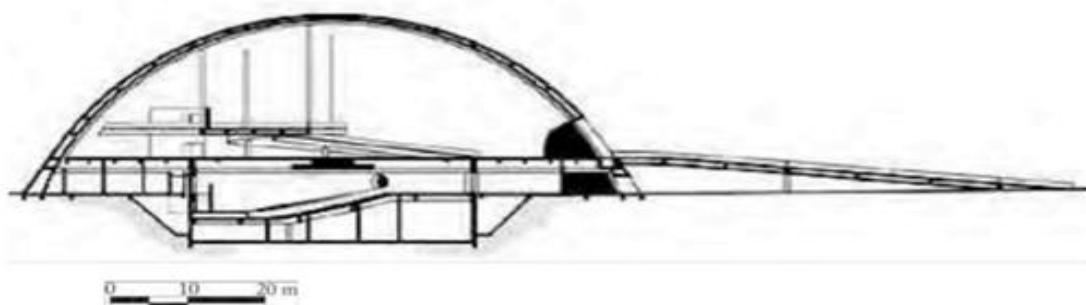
Museu de Brasília (2006) – versão construída – corte – rampa reta. Projeto Design. Duas obras levam Niemeyer ao Planalto Central, nº 326,207, p.61
